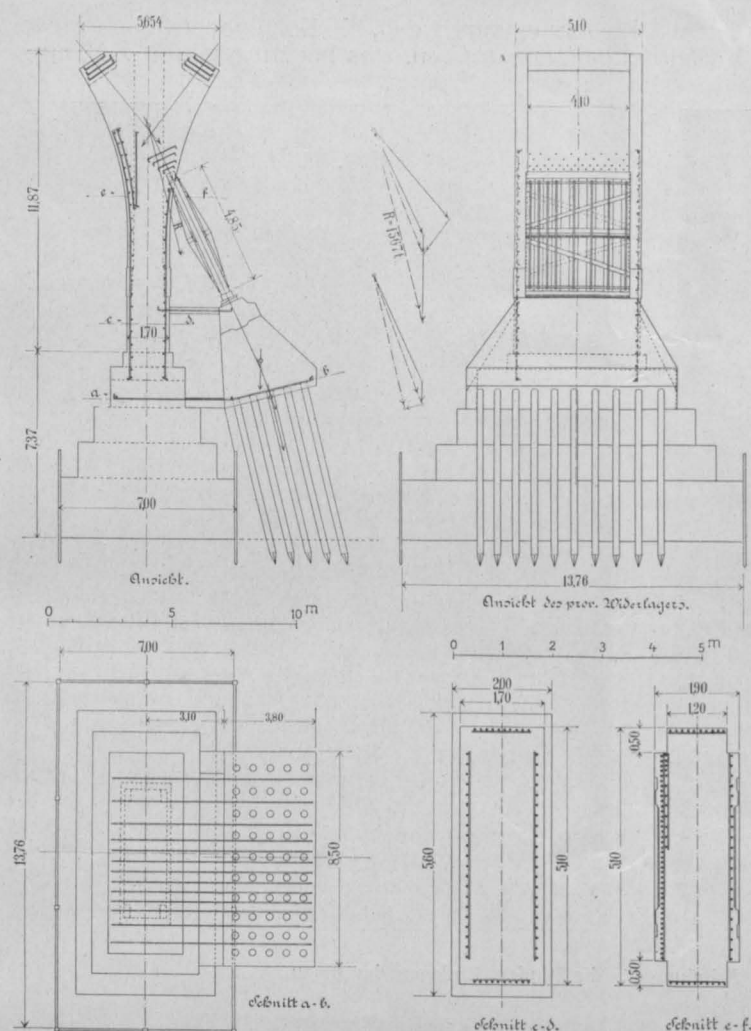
Armierung der Bogenpfeiler und provisorisches Widerlager.
